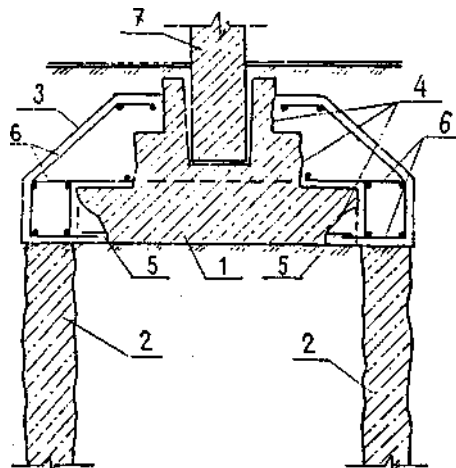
Передача навантаження від фундаменту на залізобетонні палі занурювані задавливанням
